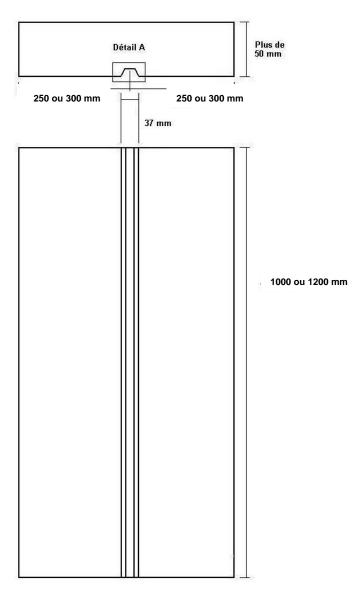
Panneaux à bossage Type 2 (dimensions en mm)
